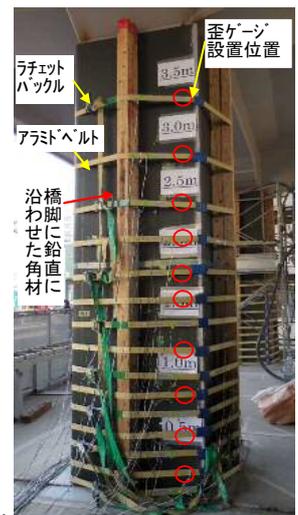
ラチェットバックル付アラミドベルト設置状況 (施工試験のため、歪ゲージを設置)
